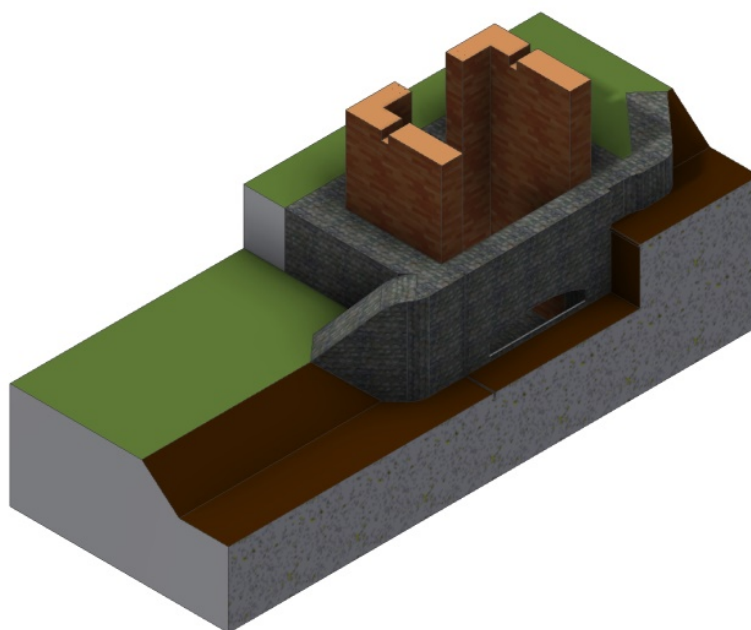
Corte longitudinal del canal donde se aprecian detalles de la fábrica de ladrillo.
